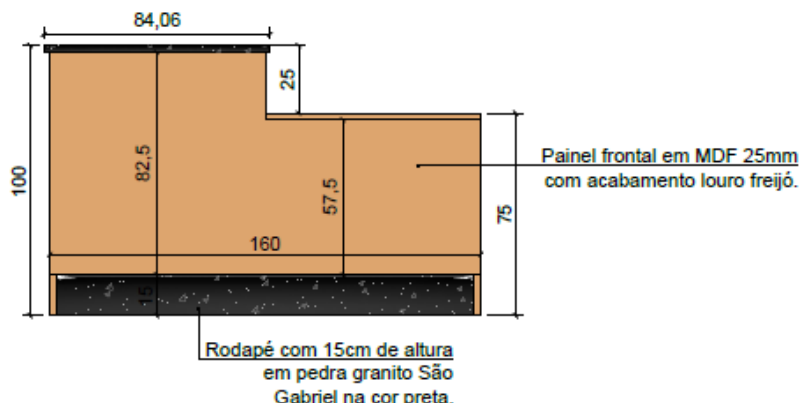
DIMENSIONAMENTO VISTA FRONTAL
